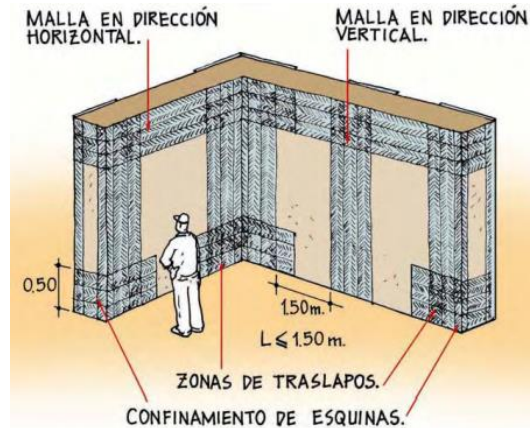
Colocación del refuerzo de mallas con vena (AIS, 2004)
